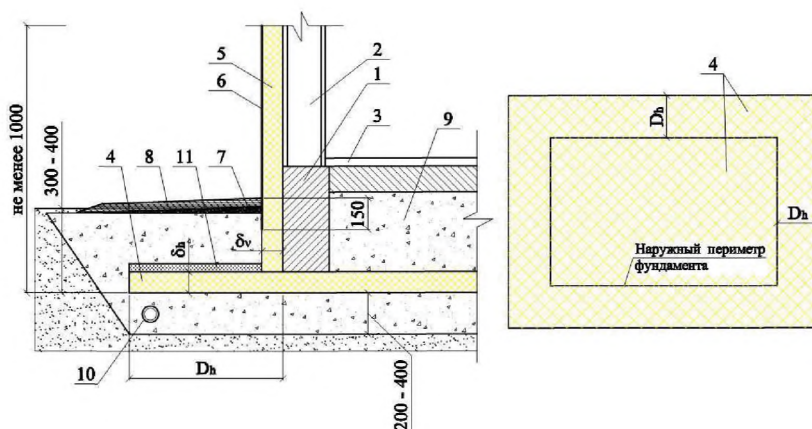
Схема укладки и параметры теплоизоляции URSA XPS в фундаментах зданий с переменным режимом эксплуатации (отапливаемое — неотапливаемое)
